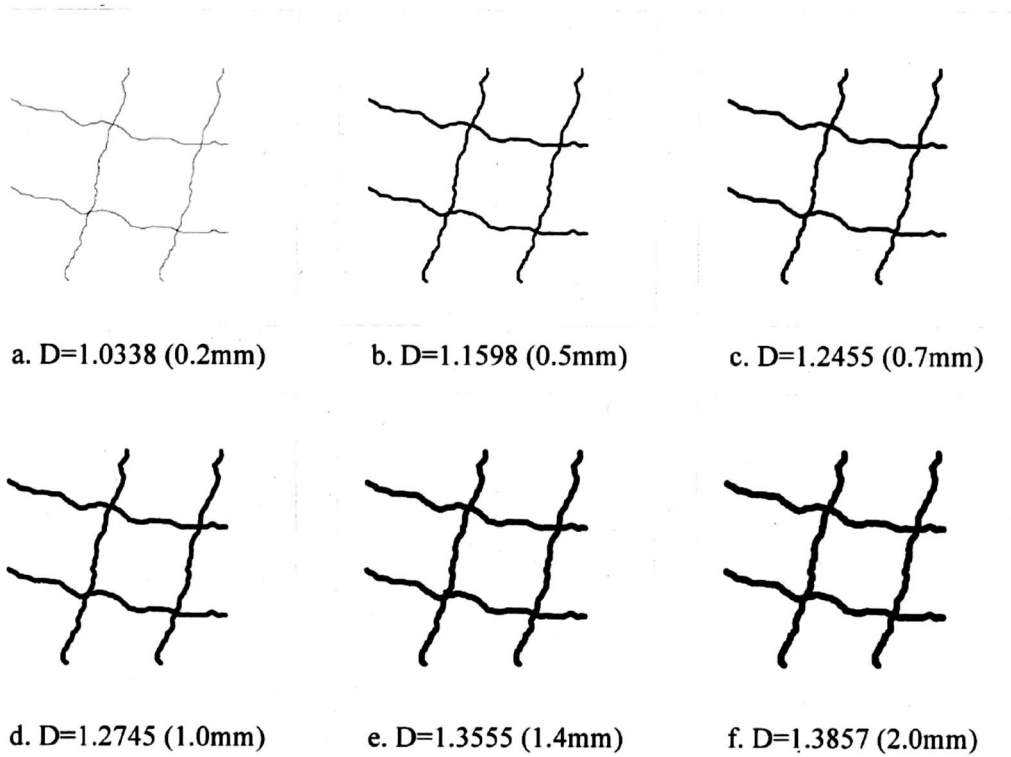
ひび割れ幅別ひび割れモデル図
